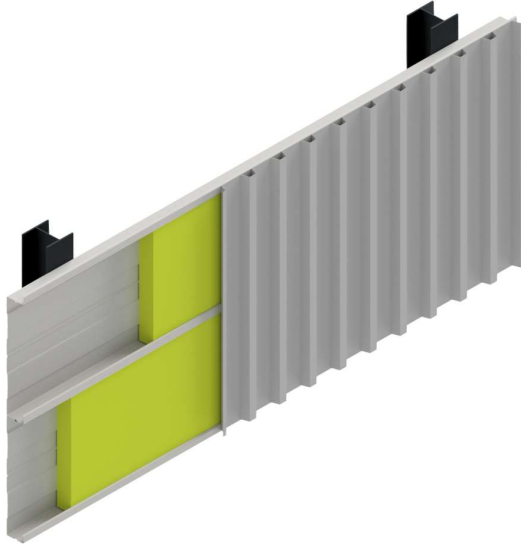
Ausschnitt einer Kassettenprofilfassade der ersten Generation mit vertikal verlegter Trapezprofil-Außenschale
